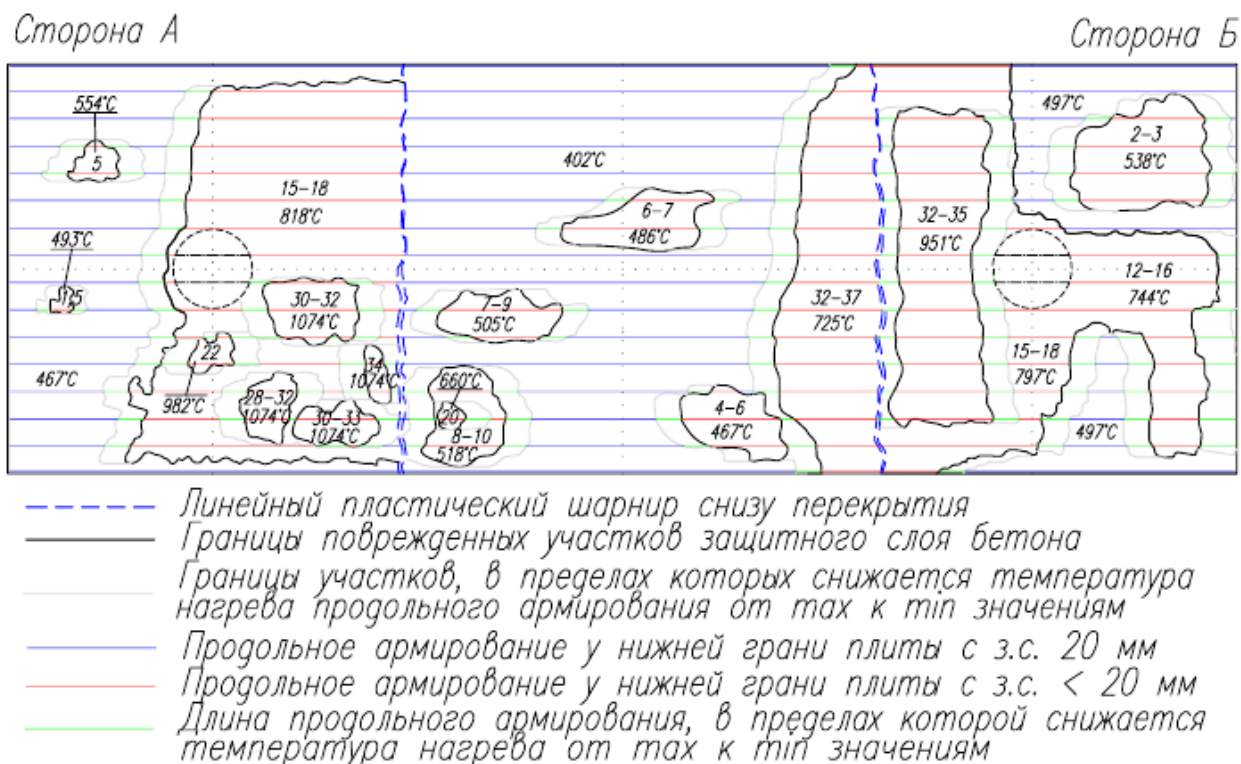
Схема прогрева рабочей арматуры по площади железобетонного монолитного перекрытия
